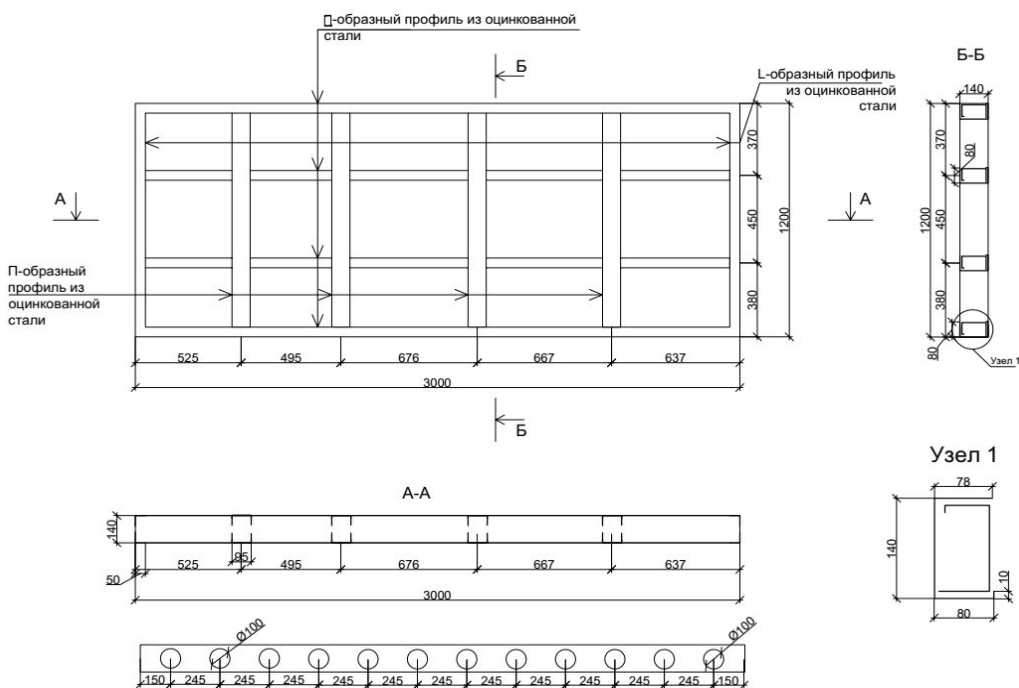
б. Общий вид термоструктурной панели (панель перекрытия с четырехполосным армирование в поперечном направлении)
